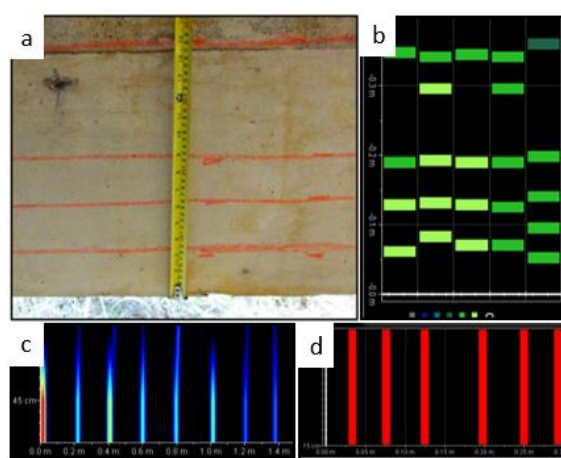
Identificação de armaduras longitudinais e transversais em uma viga de ponte
